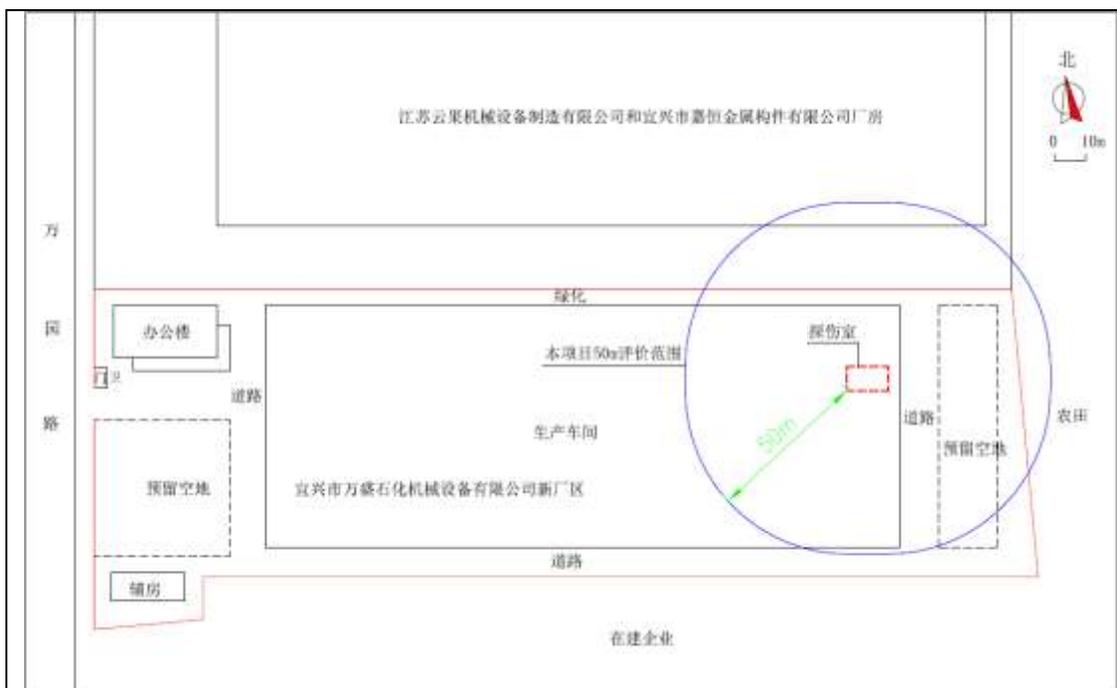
宜兴市万盛石化机械设备有限公司新厂区平面布置及周围环境示意图
